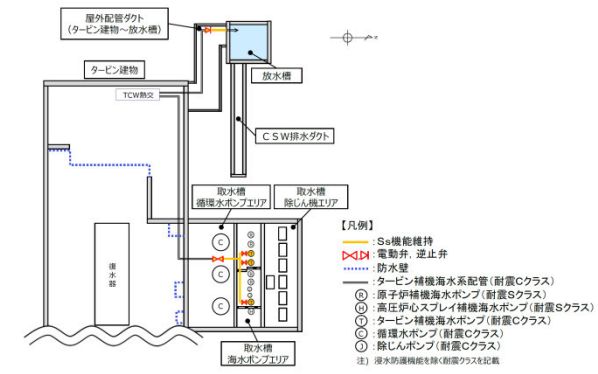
タービン補機海水系の対策概要 (平面図)
